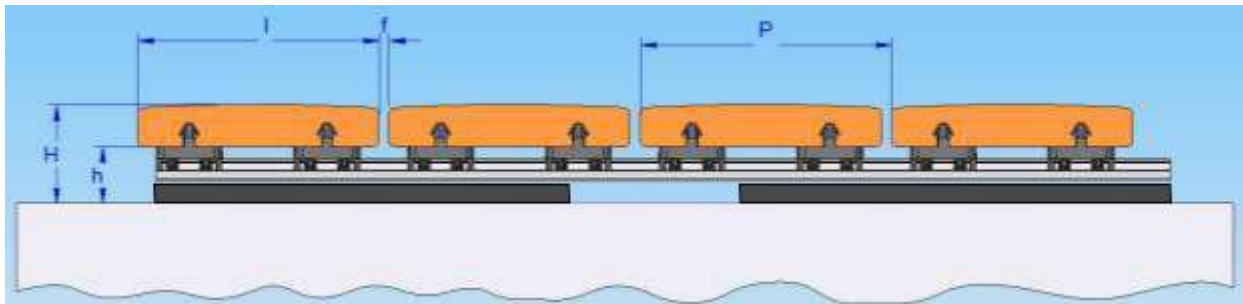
sezione trasversale dei listoni in legno fissati su sottostruttura in alluminio KIT 50 ad altezza fissa
